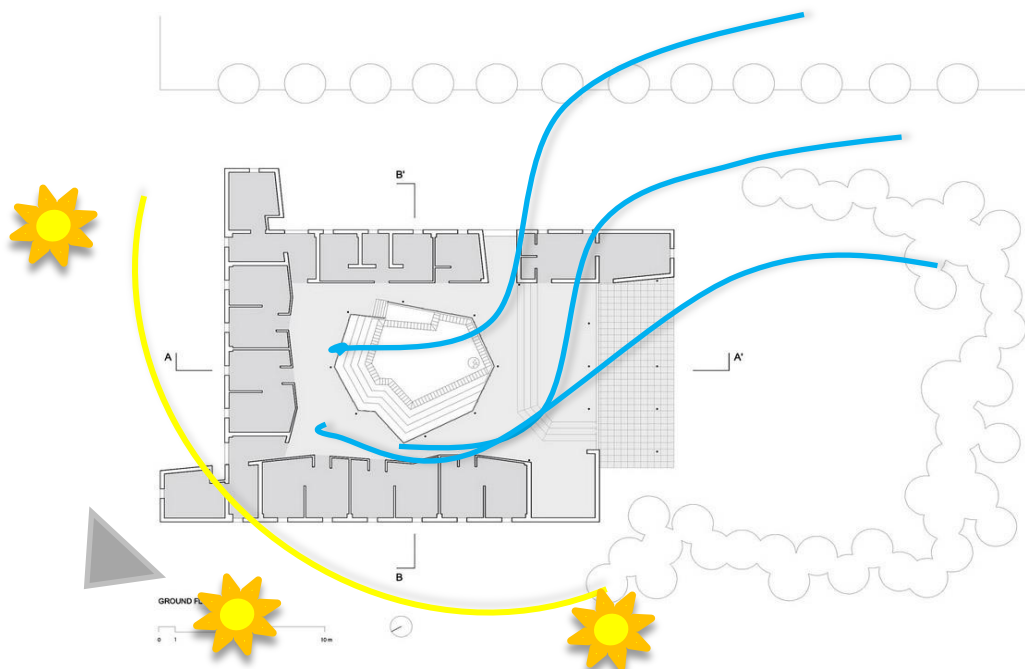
Asoleamiento y Ventilación. Elaboración propia
